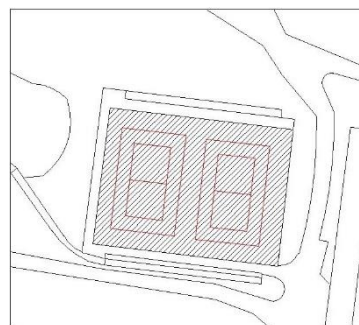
Pista de juego en liga (2 pistas de 14x22 m)
